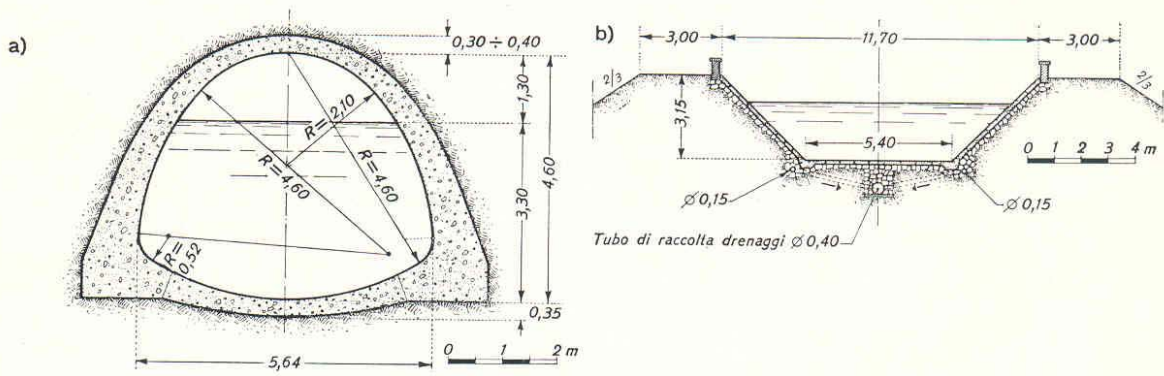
CANALE DI RESTITUZIONE — a) Sezione tipo in galleria artificiale. - b) Sezione tipo all'aperto.
